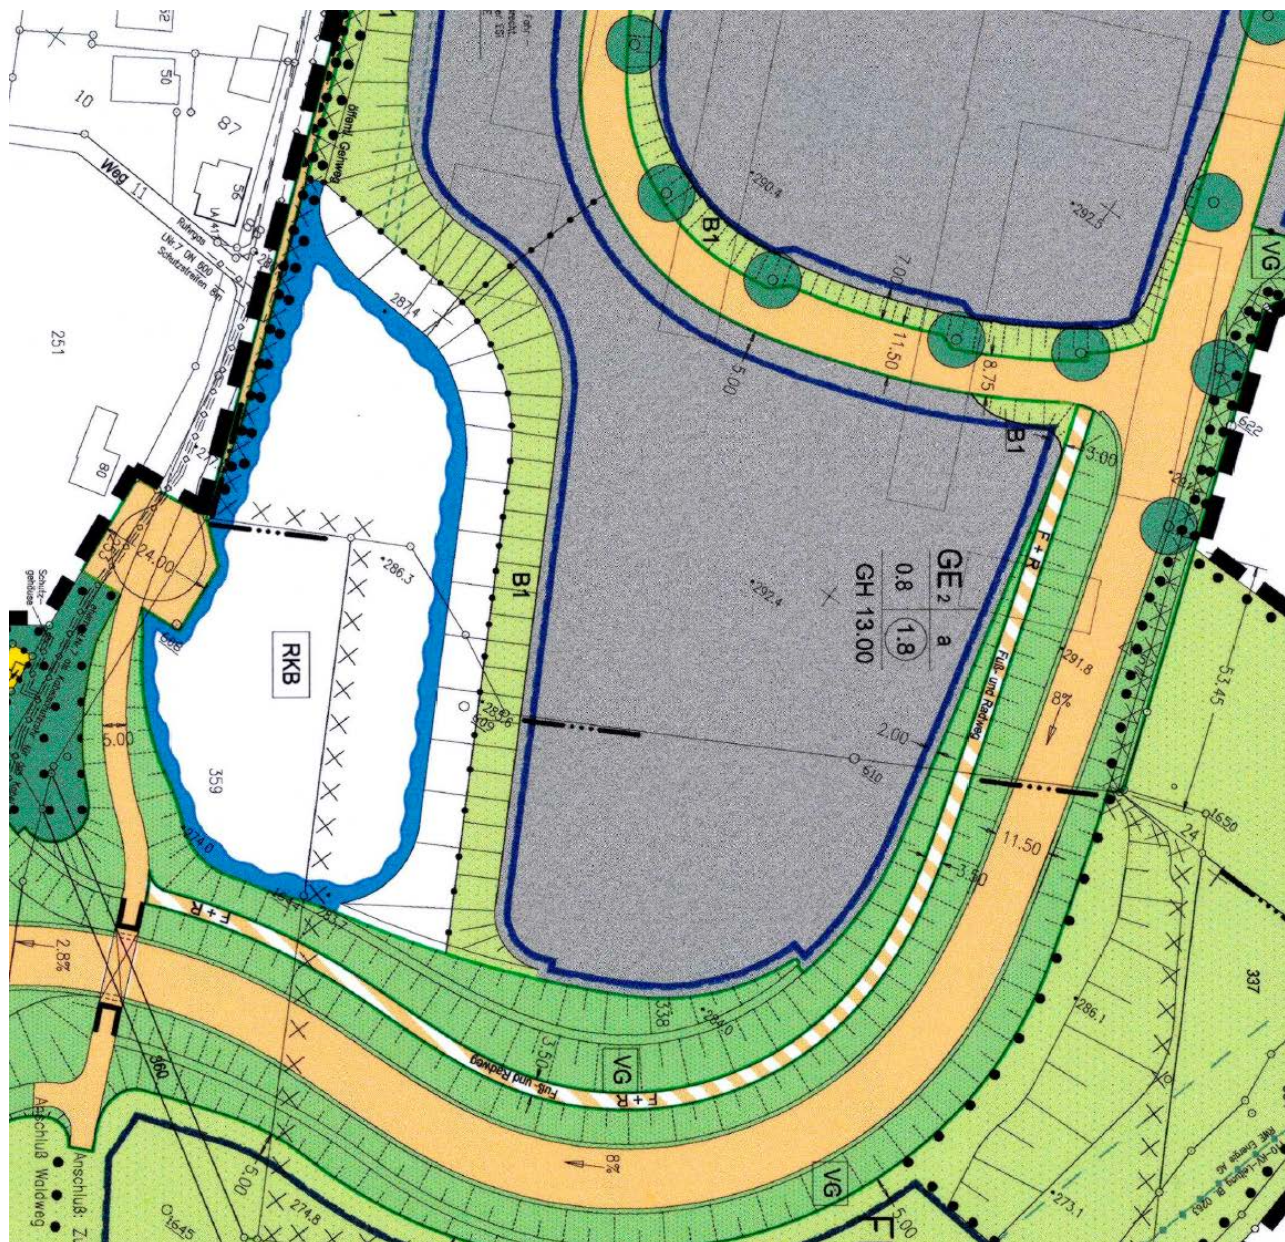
Bebauungsplan Nr. 298 „Heidenberg“, Ausschnitt
